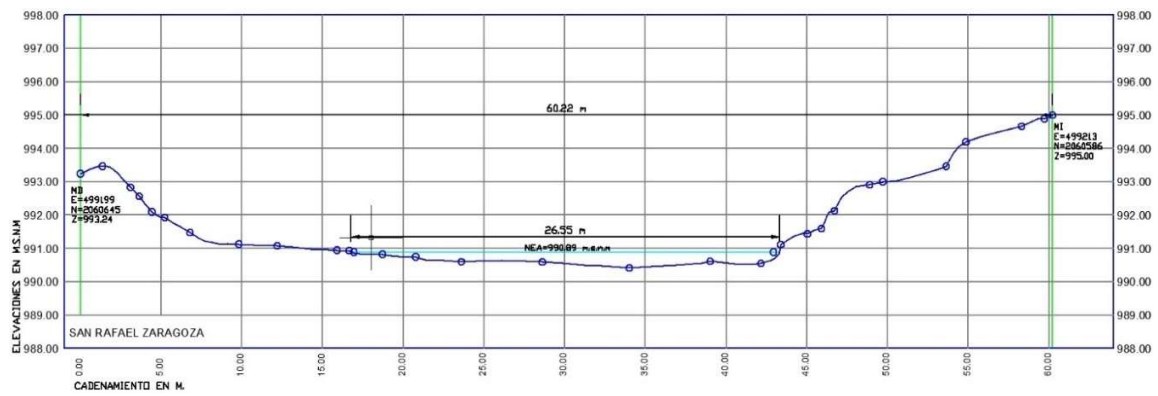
318. Sección transversal del río Cuautla en San Rafael Zaragoza
